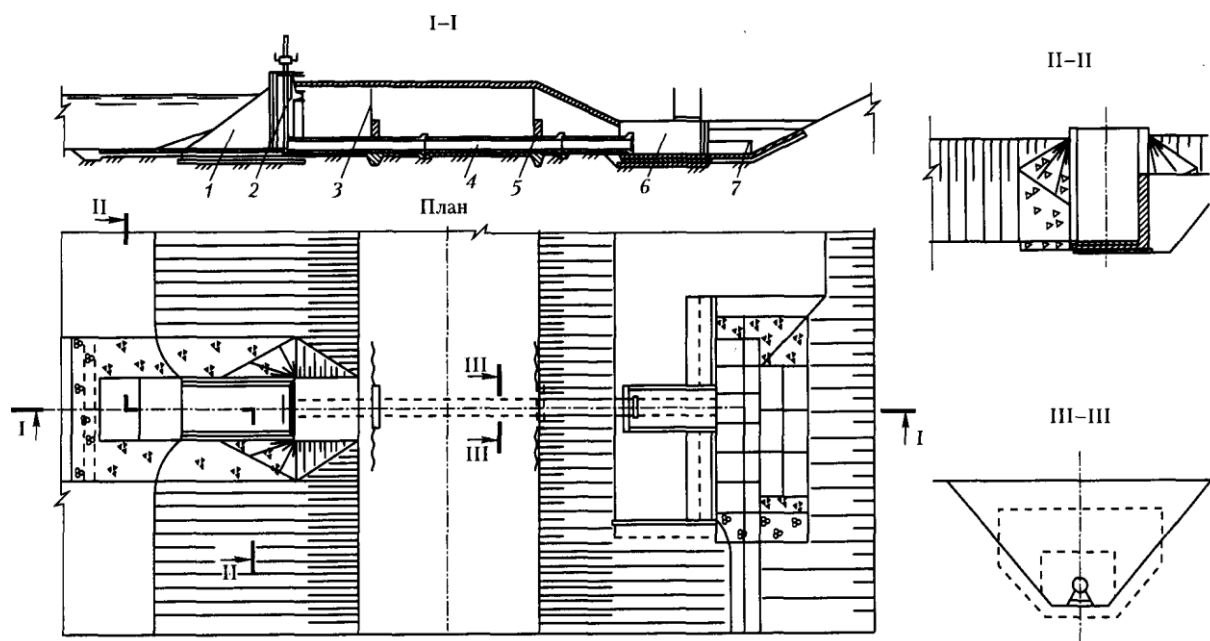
Водоспуск из пруда в канал (ОАО «Полесьегипроводхоз»):
